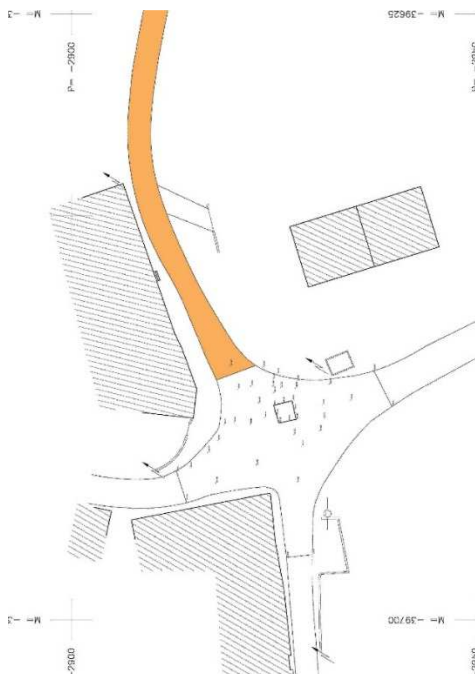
Planta do troço de Calçada de N.ª. Sr.ª, da Conceição. Fonte: Câmara Municipal de Ourém
